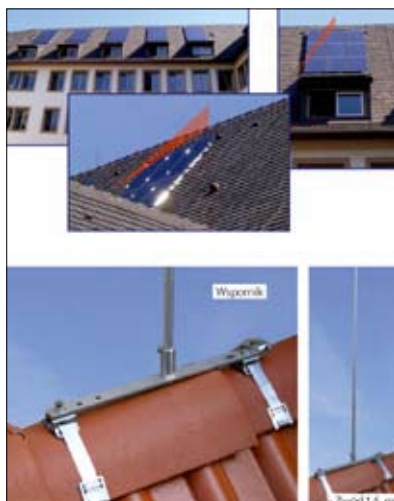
| Ochrona odgromowa paneli fotowoltaicznych na dachu budynku – wykonanie zwodu pionowego zamontowanego w podstawie betonowej
